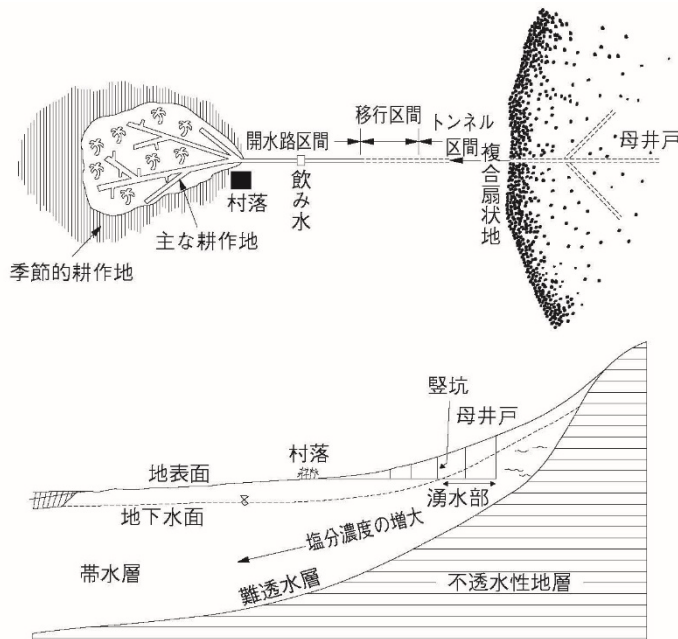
カナートの平面図及び断面図（アラビア半島の事例）
